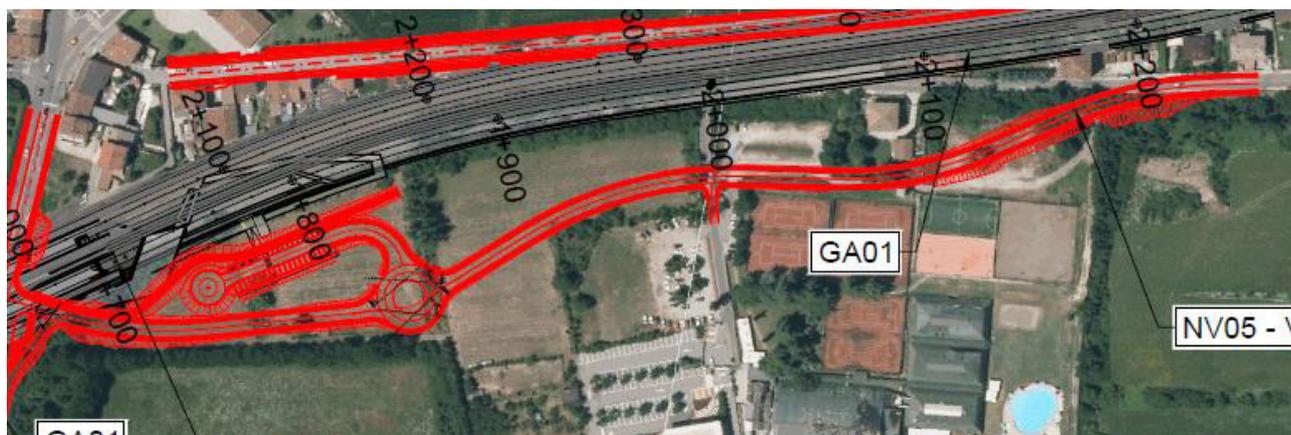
NV05 – Stralcio planimetrico su ortofoto di Via L. Fava
